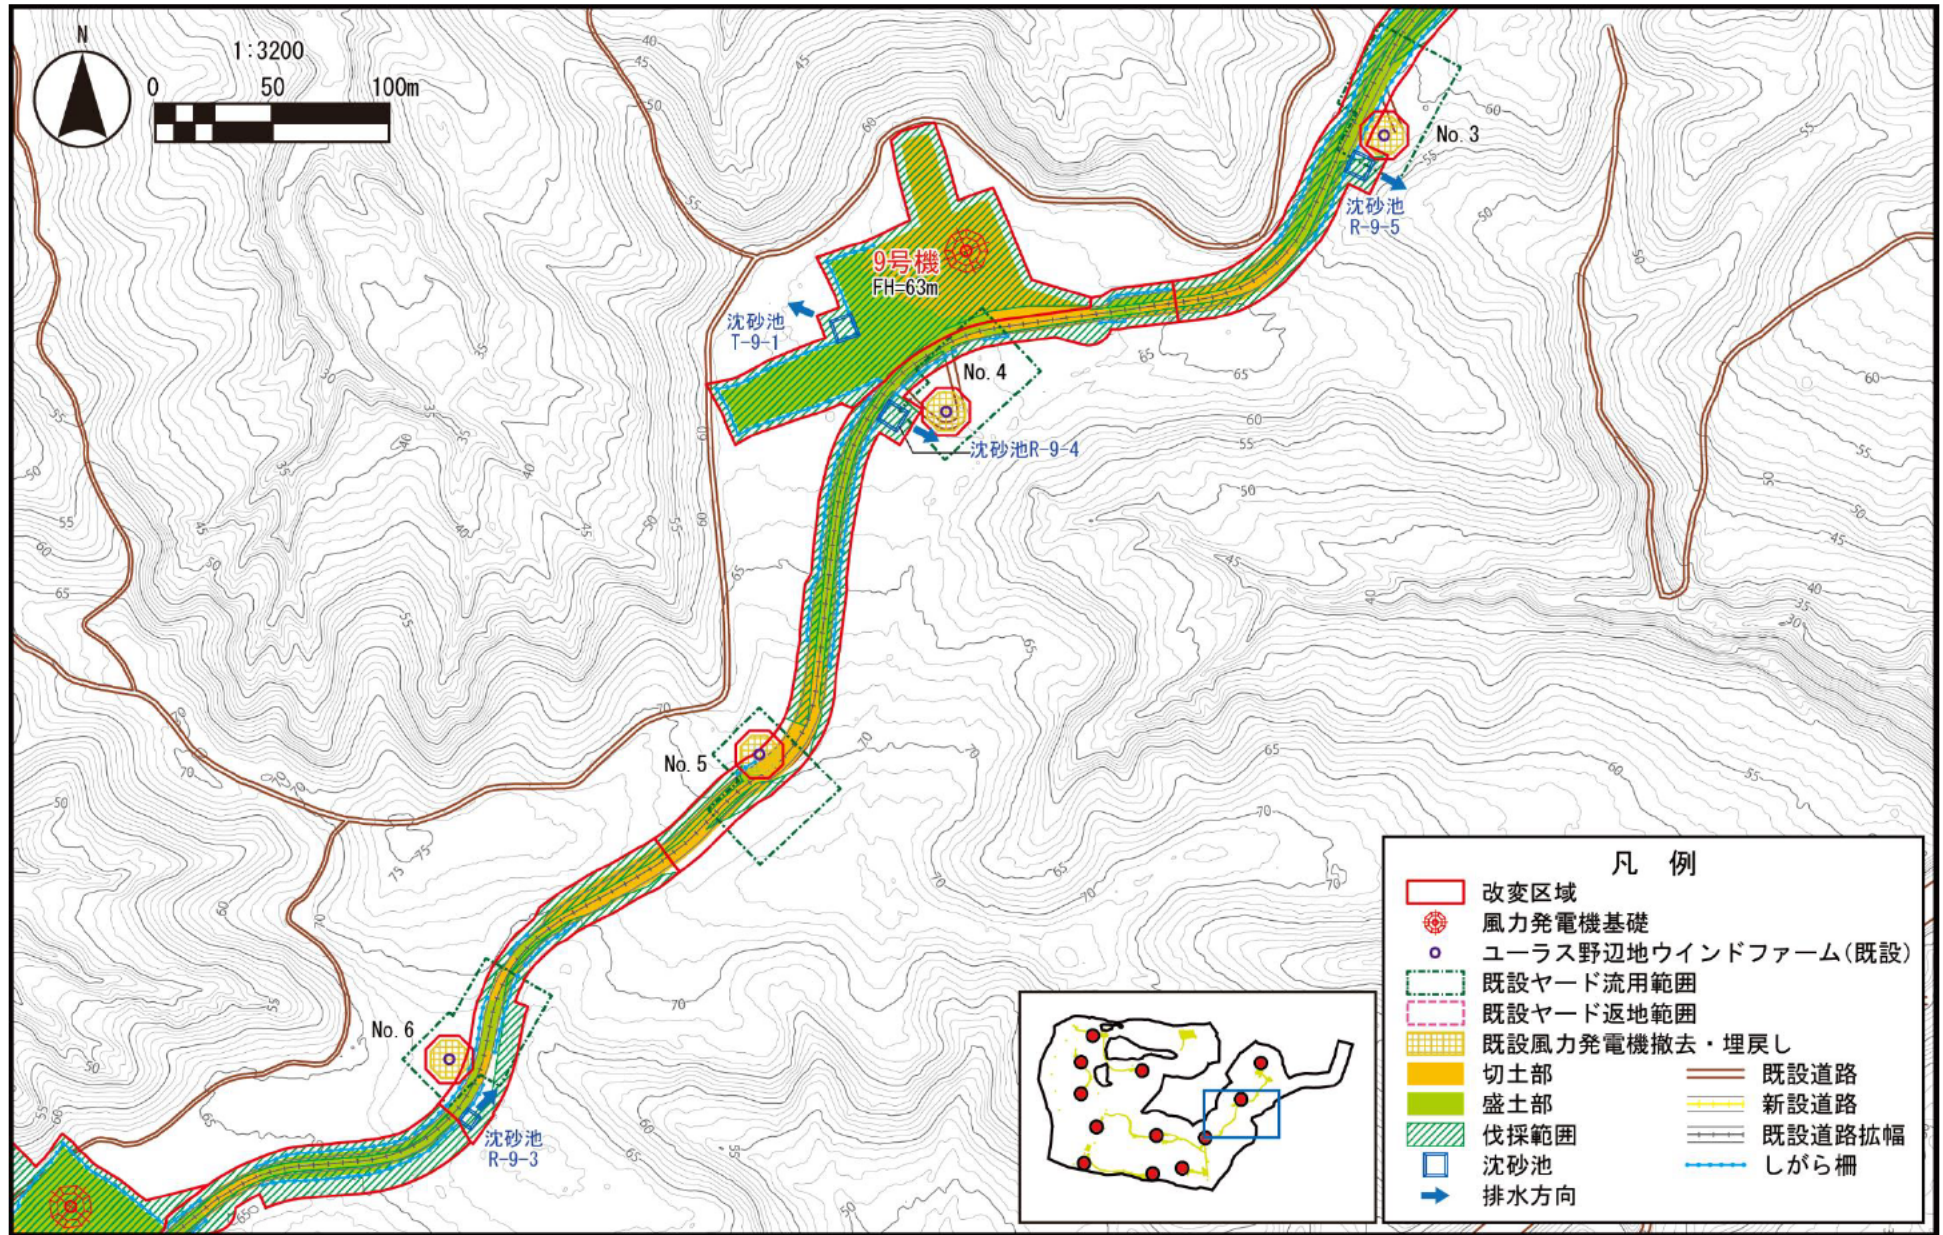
(8) 造成・基礎工事に伴う改変区域図 (平面図)
